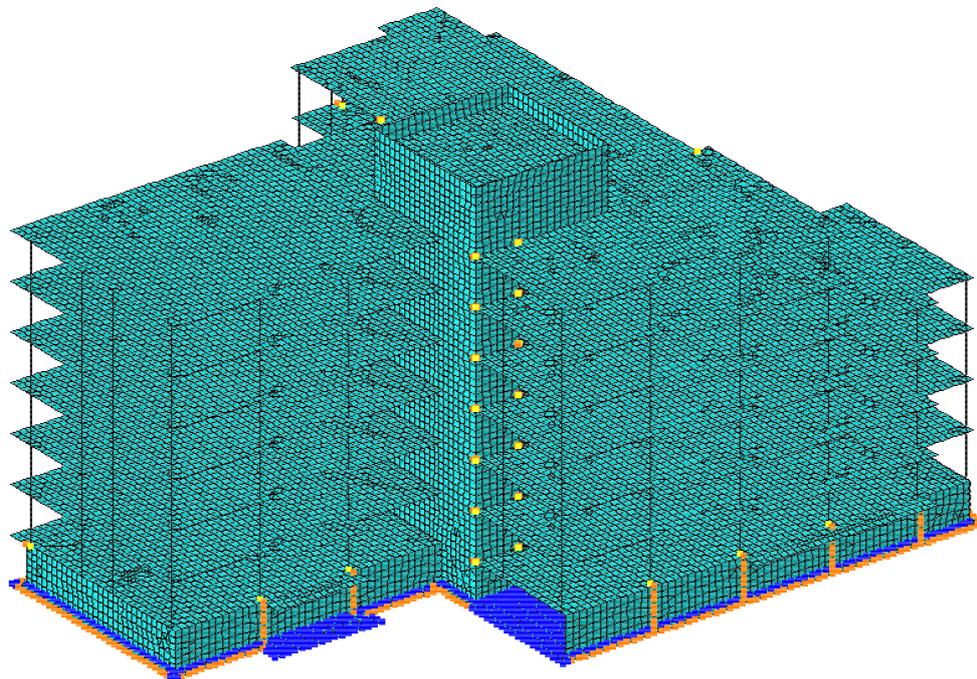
Расчетная схема здания в ПК Лира
